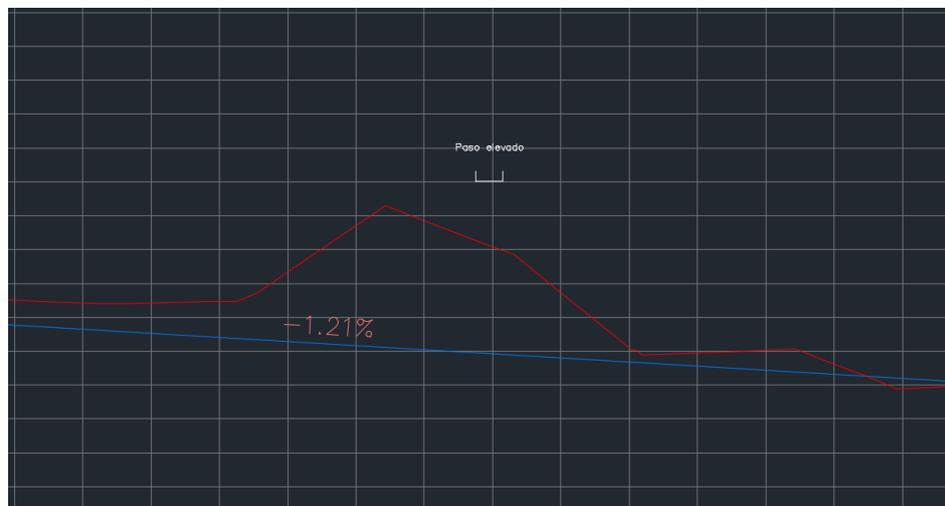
Aumento de cota bajo paso elevado en P.K. 6+303 por modificación trazado en alzado
